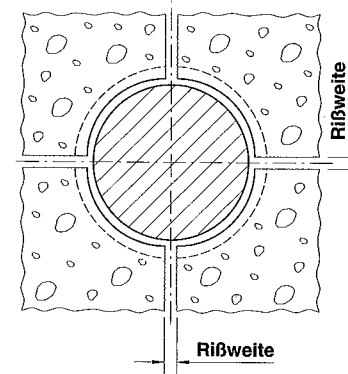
Zykon-Anker in Beton bei Entstehen eines Kreuzrisses
